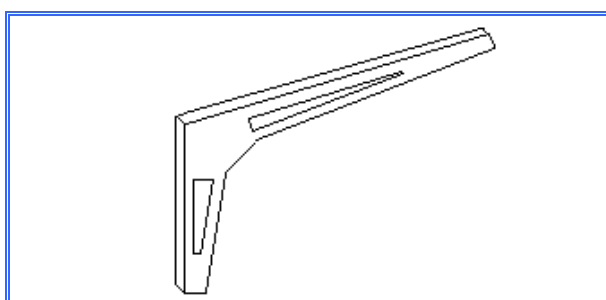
Залізобетонна рама для сільськогосподарських будівель
